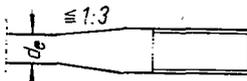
Aufgestauchtes Stabende mit Gewinde für verschraubten Stoß
